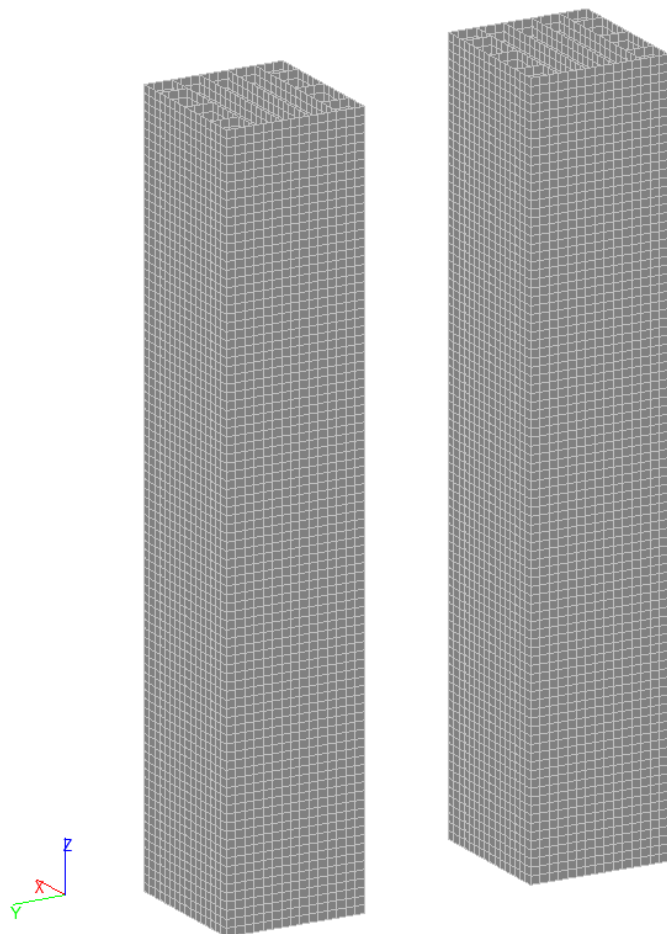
Схема ядер жесткости на всю высоту здания
